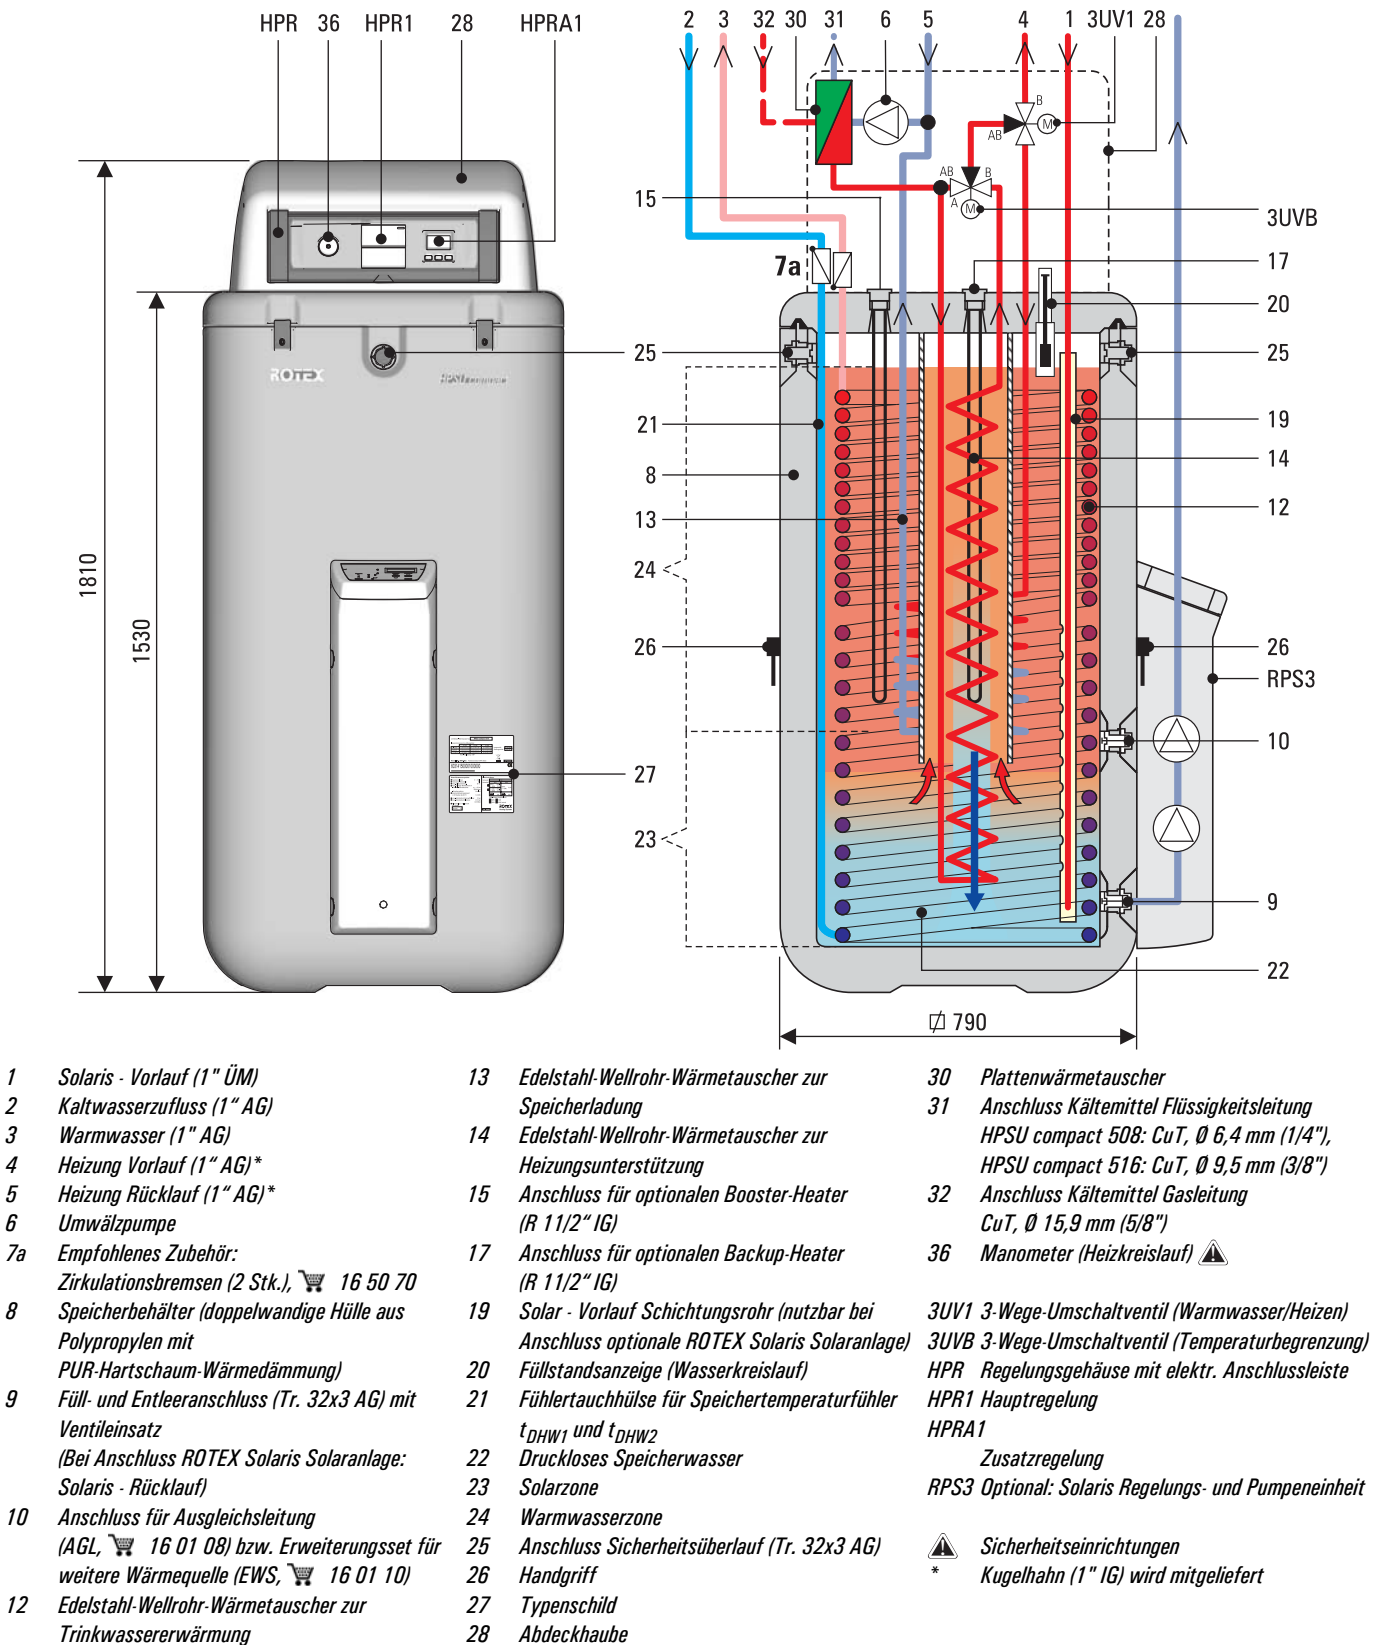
Anschlüsse und Abmessungen HPSU compact (Seitenansicht und Innenaufbau)
